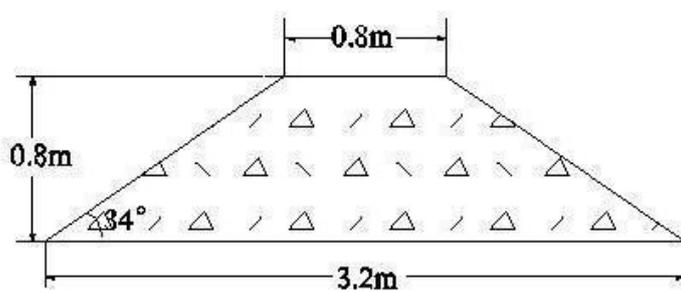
露天采场边坡挡水围堰断面示意图 (单位: m)
